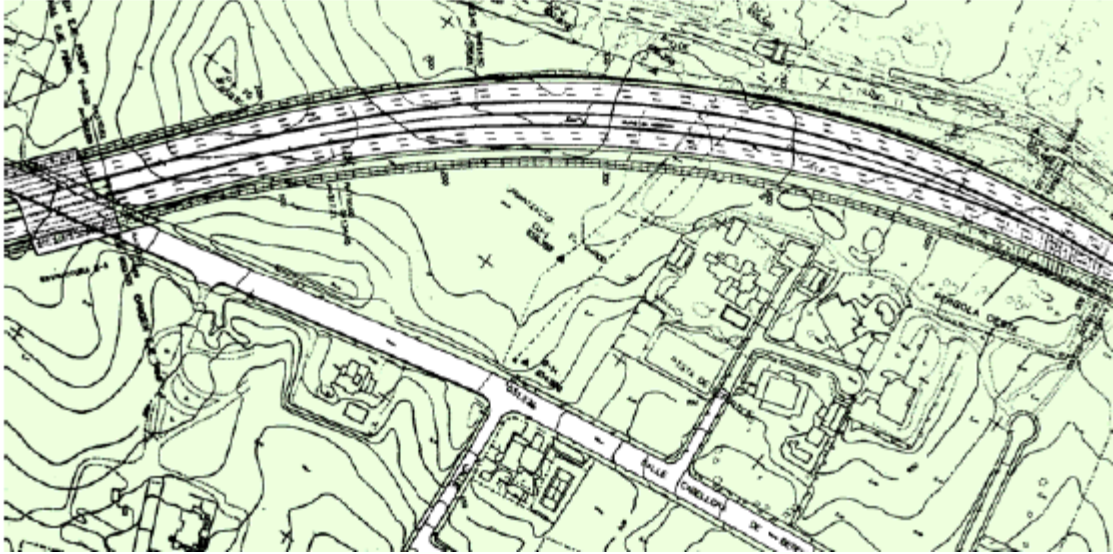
Planta de trazado de una vía de calzadas separadas.
